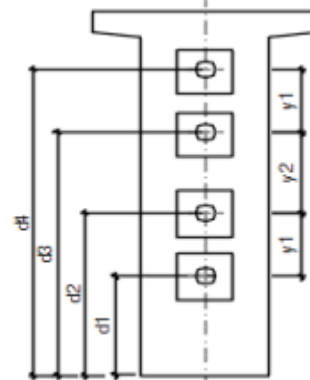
Disposition des appareils d'ancrage dans la section d'about
